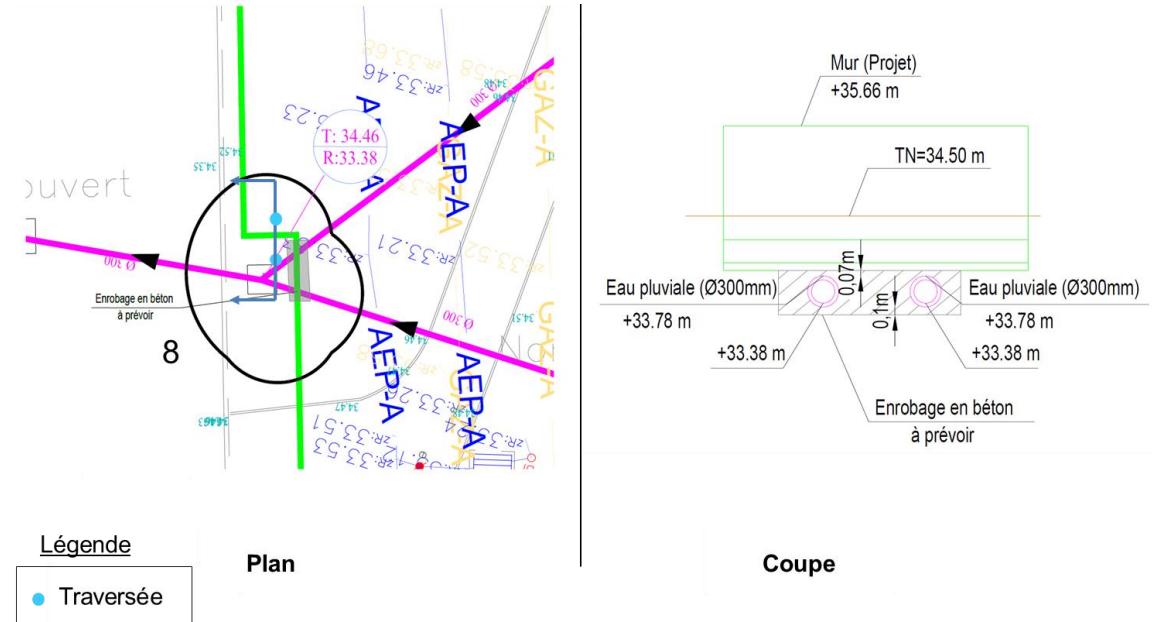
Mur traversant deux conduites d'eau pluviale
